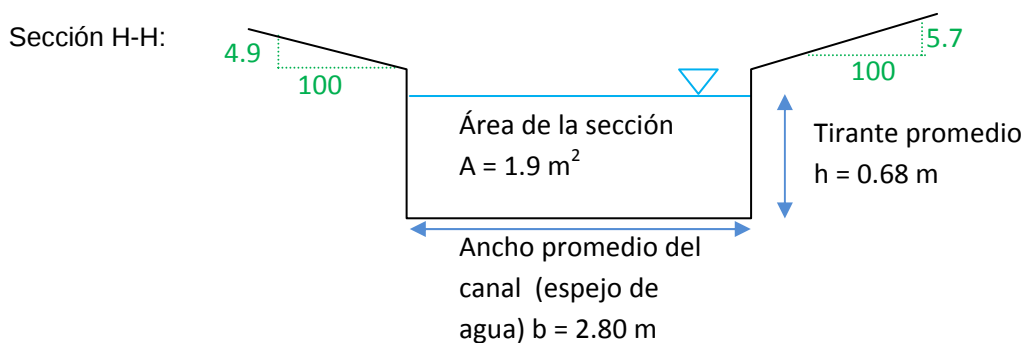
Secciones transversales levantadas el 5 de agosto de 2011.
